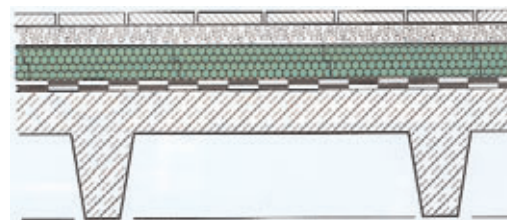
Schichtaufbau des Terrassendachs mit Splittbett, T 2.
